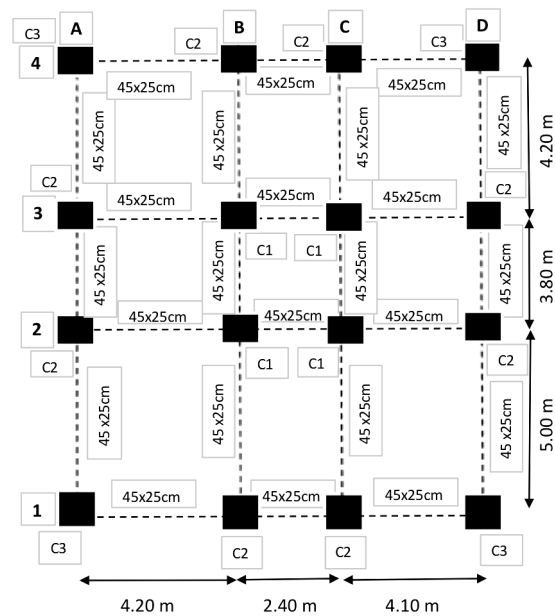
Esquema de columnas y vigas de la vivienda de hormigón armado.
